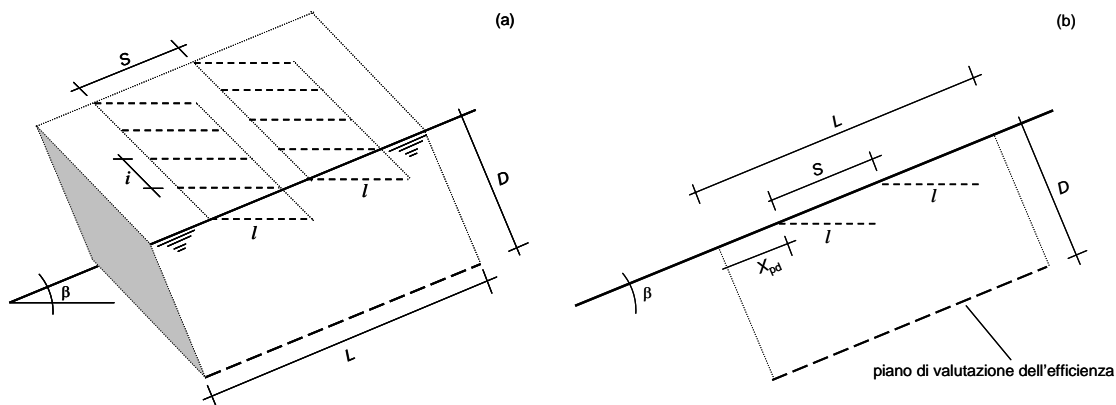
Schema di installazione dei dreni: (a) vista assonometrica; (b) sezione longitudinale
